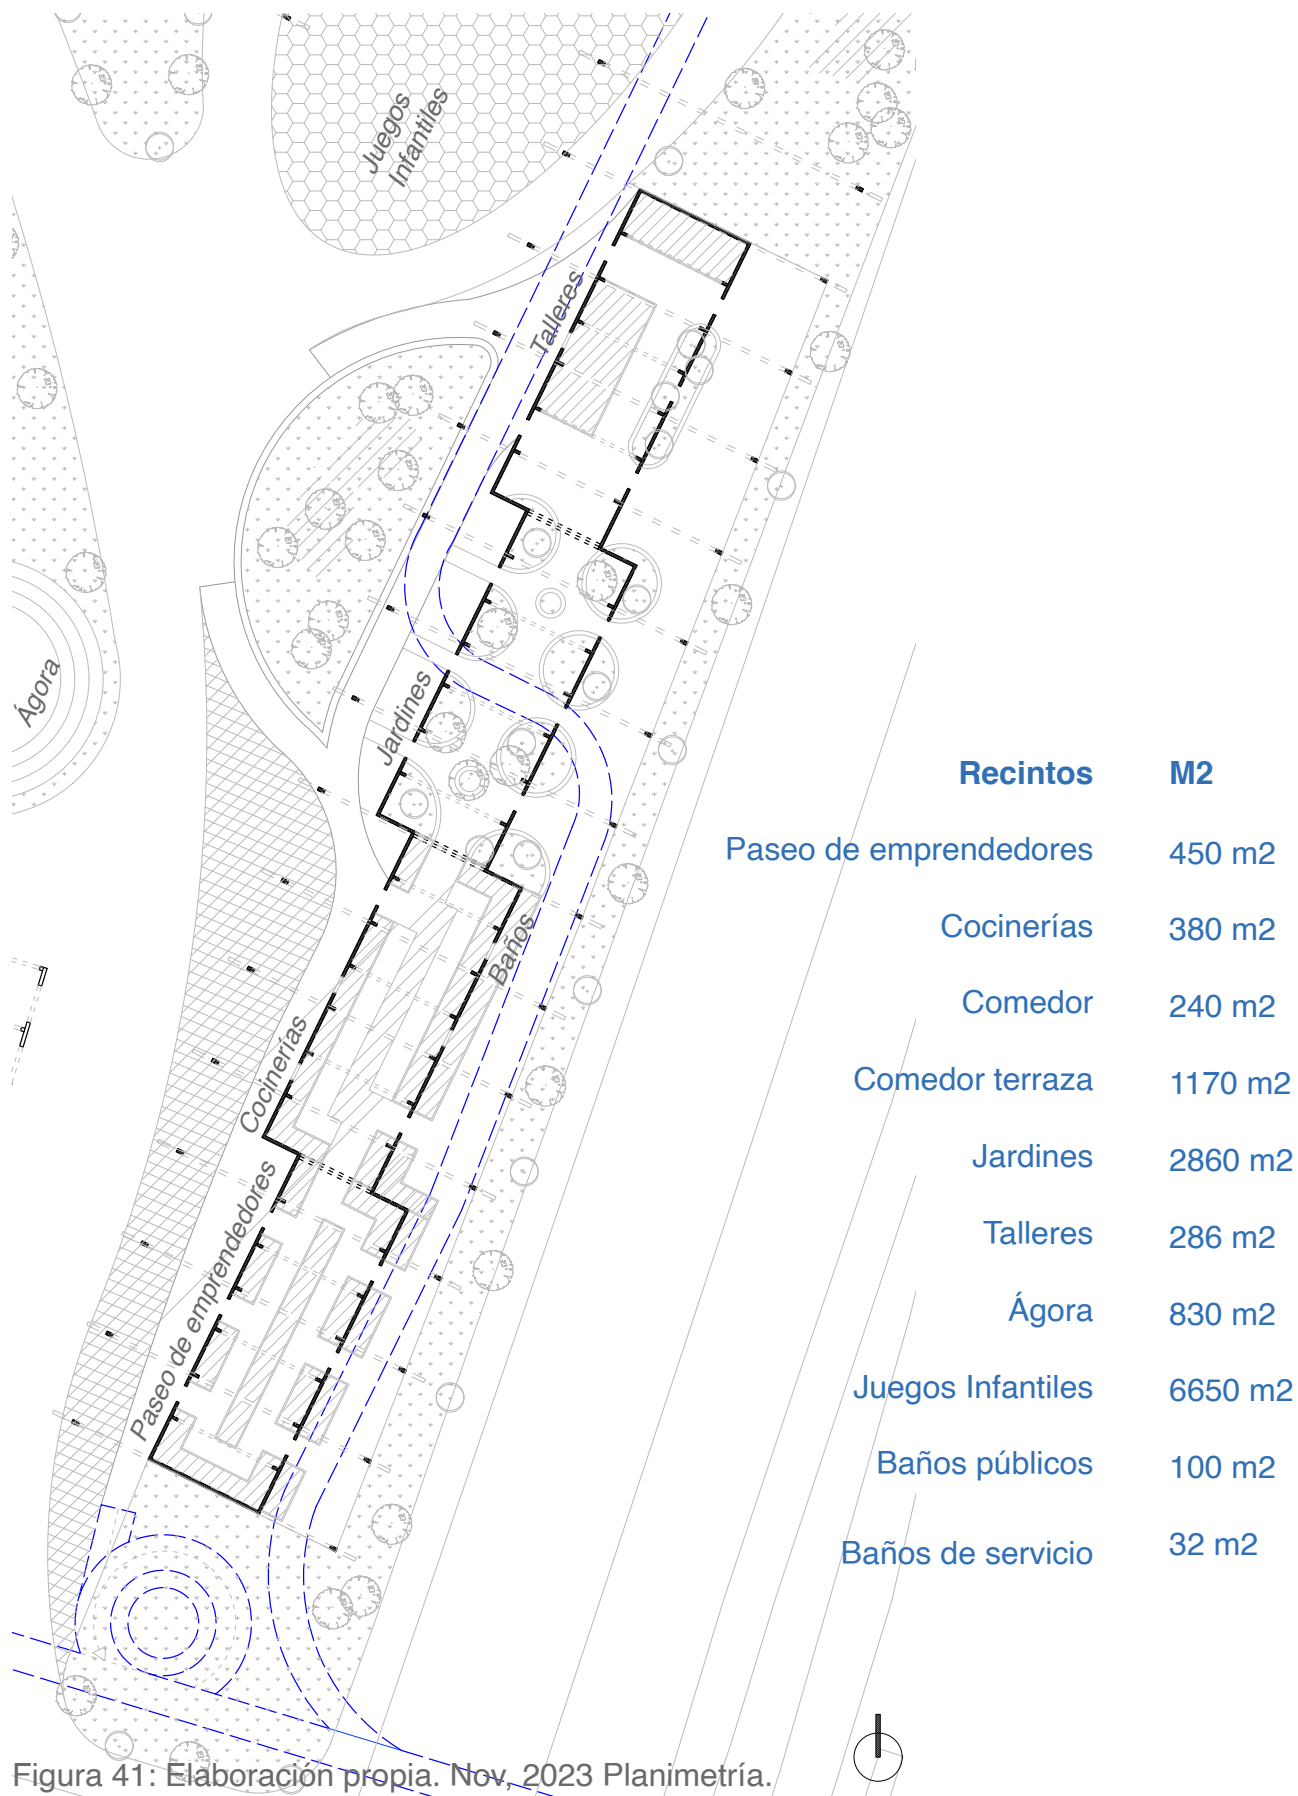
Elaboración propia. Nov, 2023 Planimetría.
